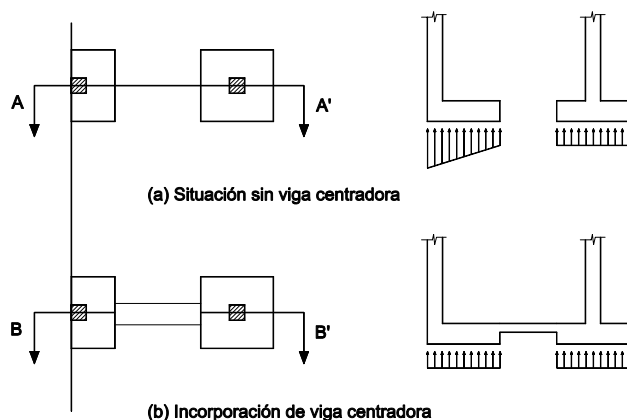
Ejemplo del empleo de vigas centradoras para redistribución de presiones sobre el terreno
